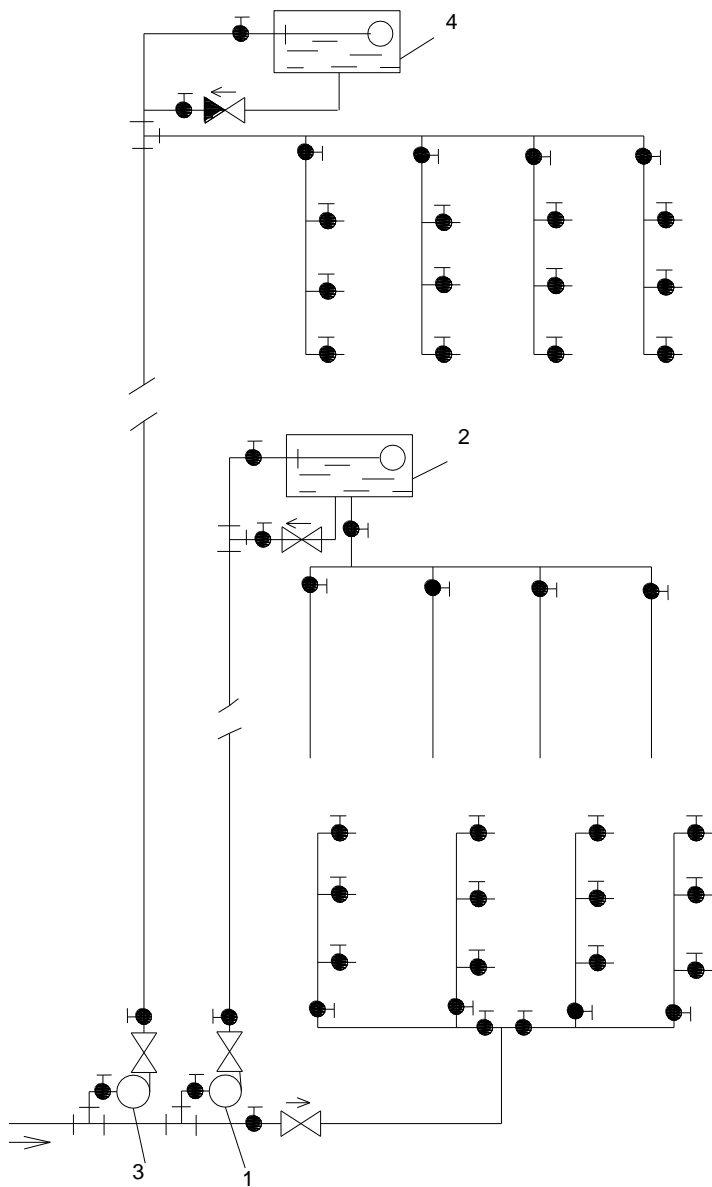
Параллельная схема зонных водопроводов зданий:
